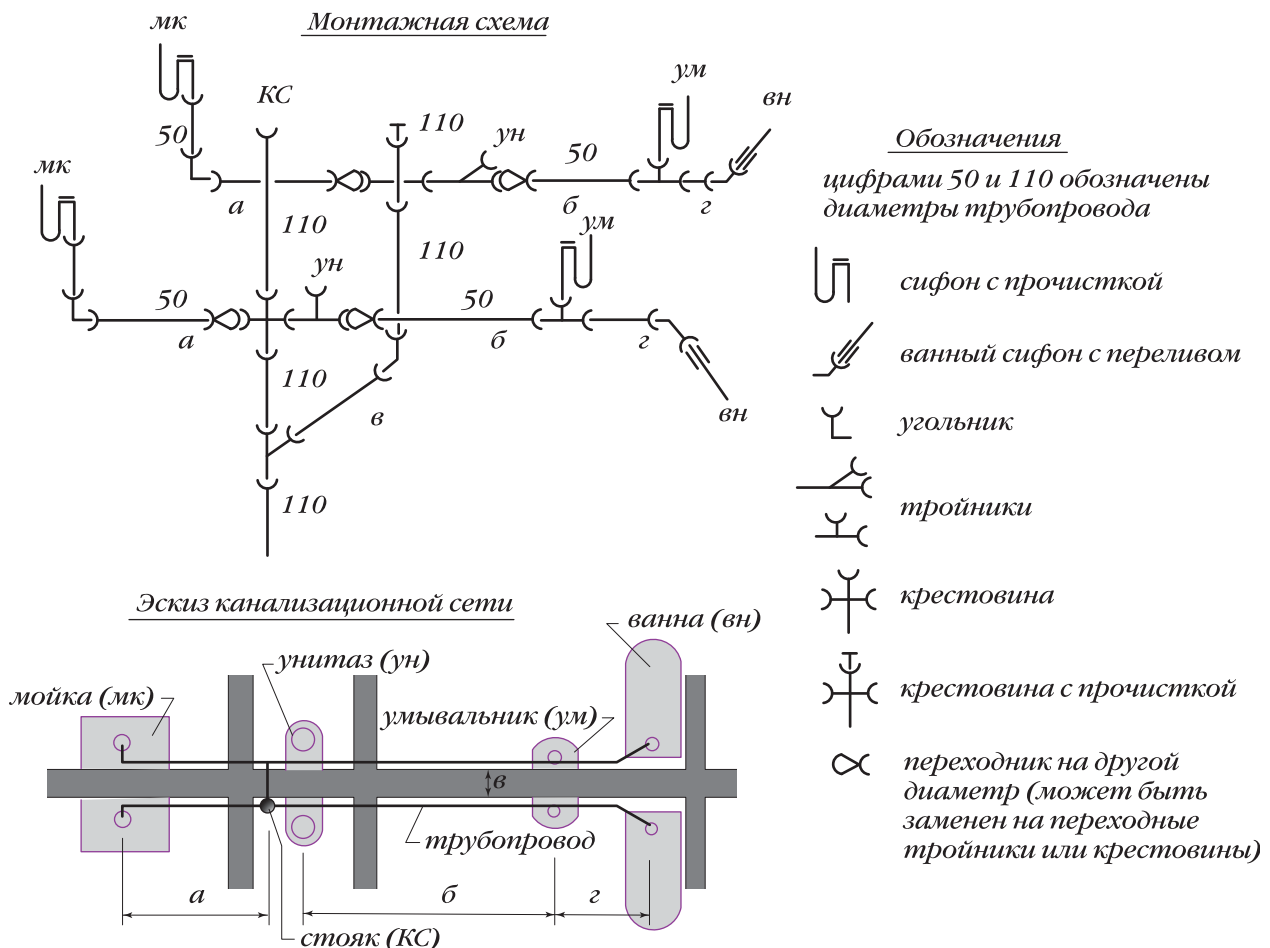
Пример монтажной схемы отводов двух смежных санузлов
